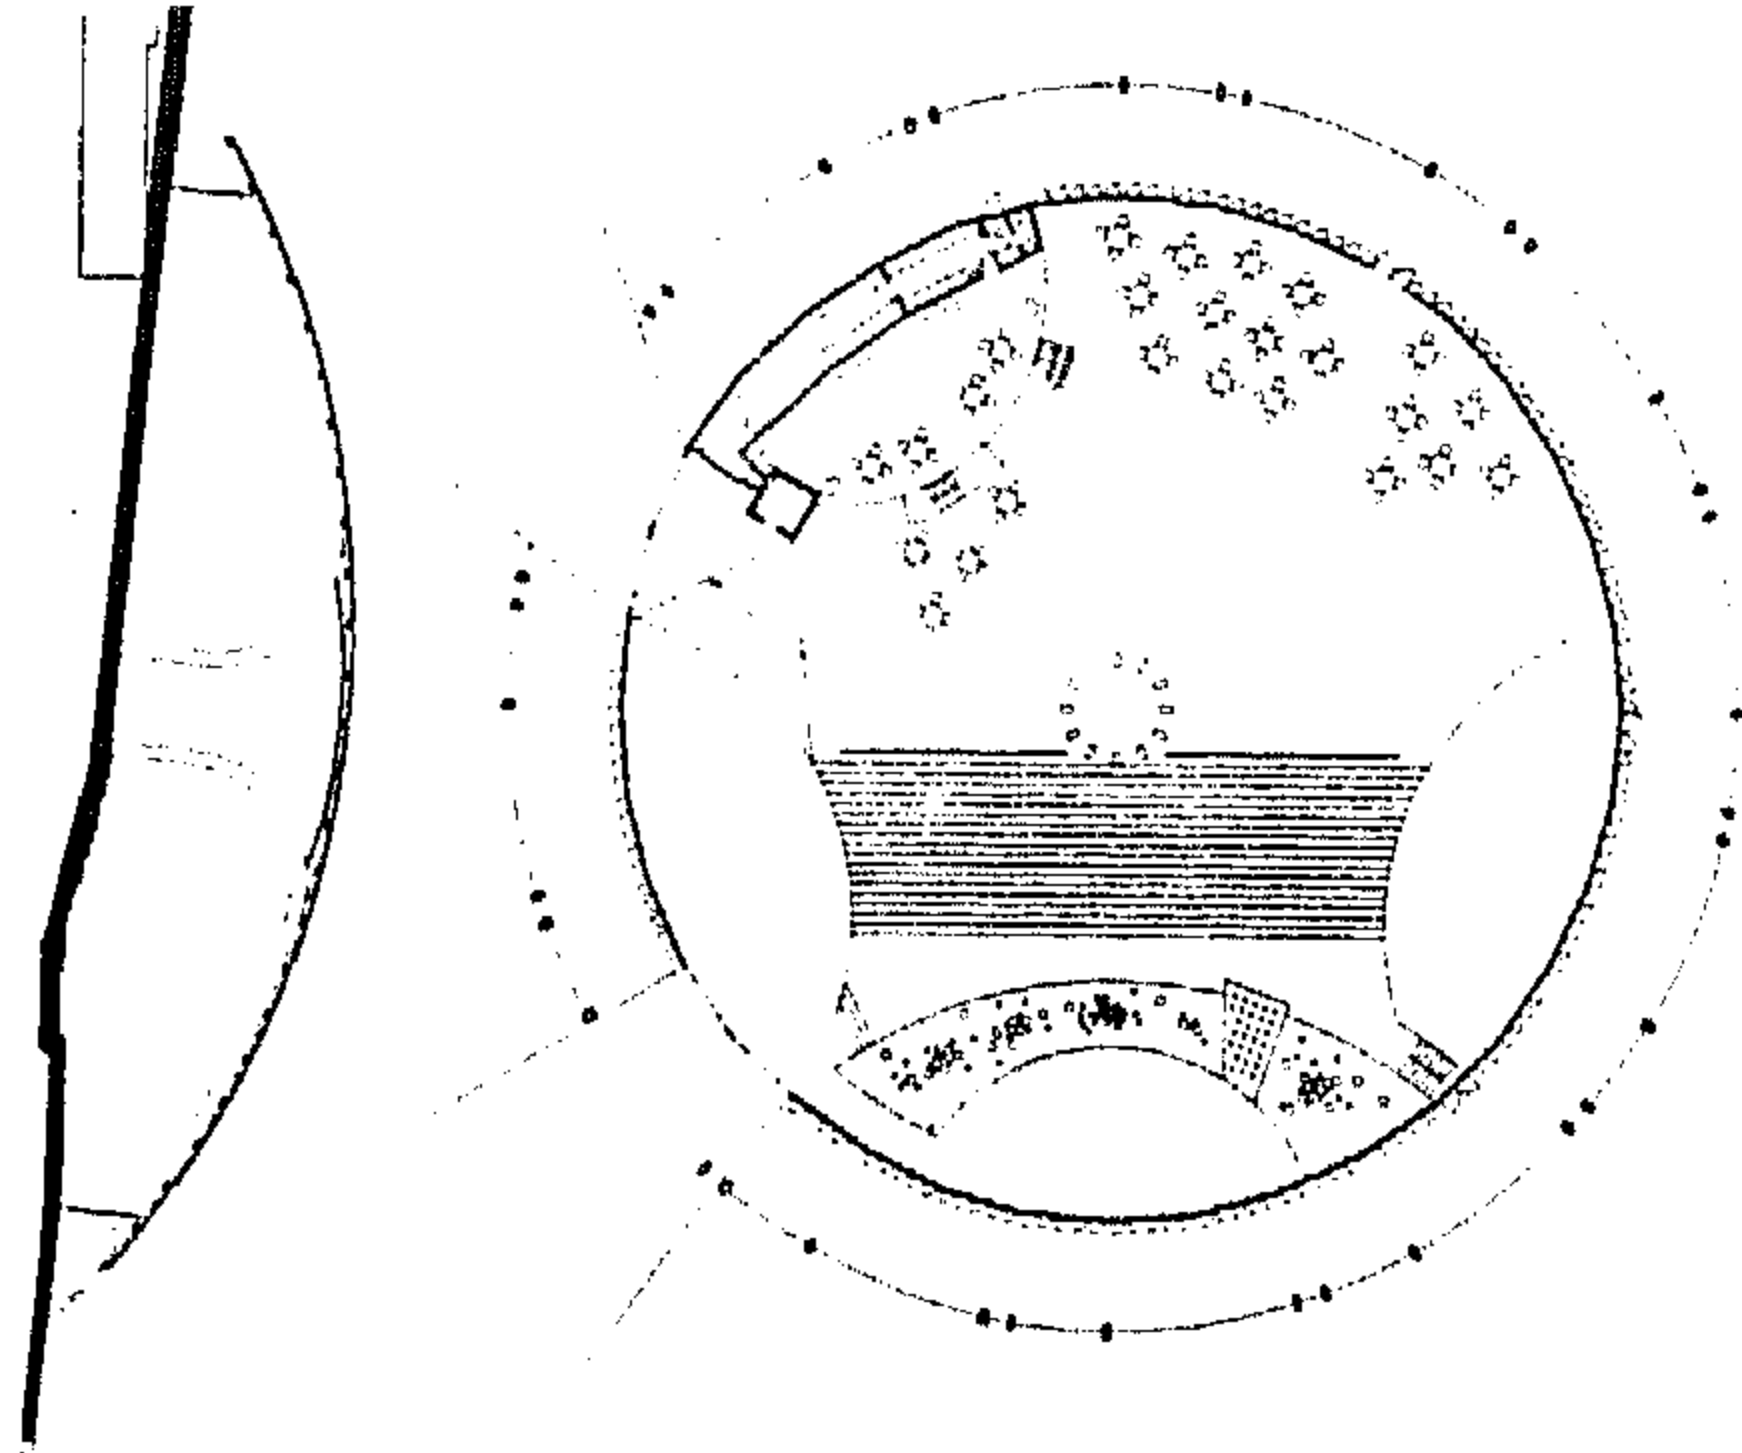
مسقط أفقي للموقع العام
